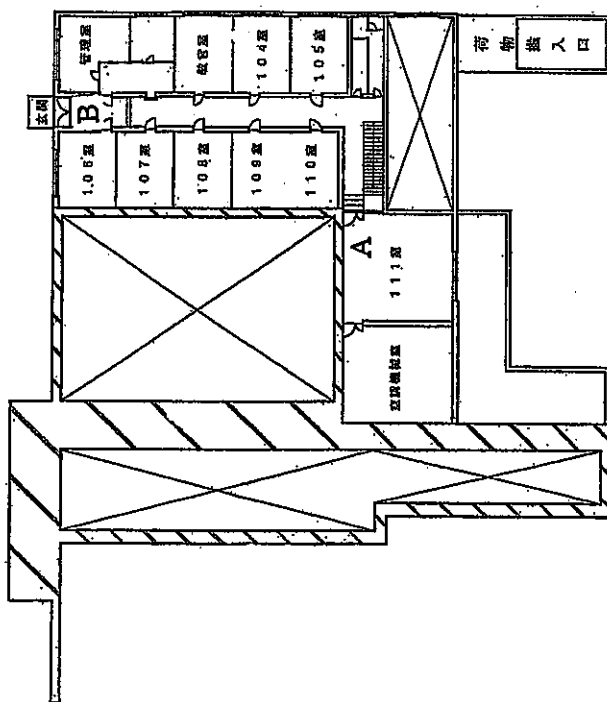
3 建屋 1 階平面図と測定点 (A 点と B 点)
